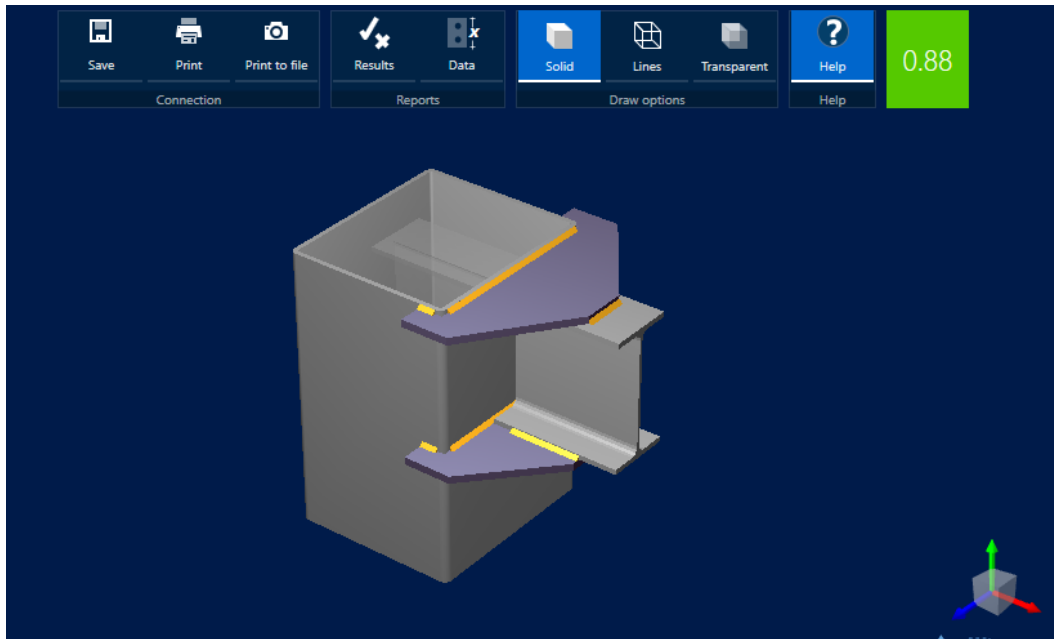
Diseño de conexión a corte columna-viga principal
